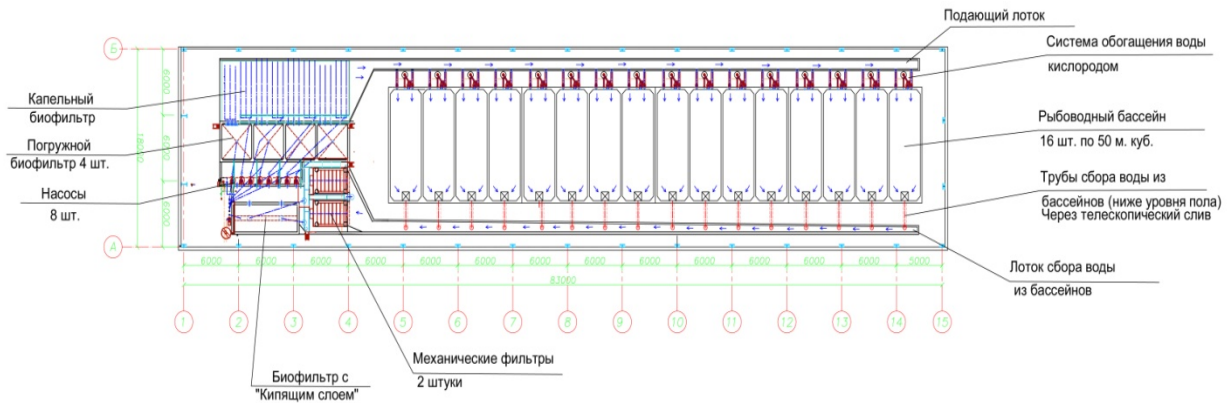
6.18 Схема УЗВ с бетонными прямоугольными бассейнами (вариант 5) для выращивания осетровых
